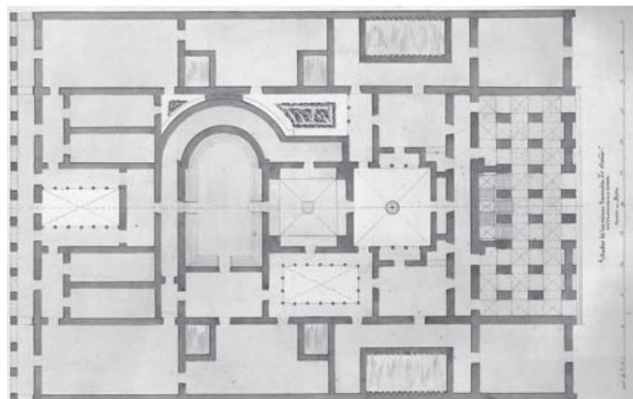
Planta de los Baños de la Reina (*Italica*) de esquema anular) (García Entero, 2007: 260).
